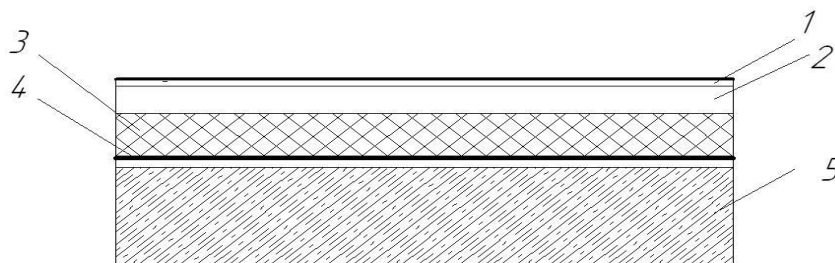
Схема для розрахунку тепловтрат через підлогу в підвальному приміщенні: 1 – керамічна плитка; 2 – стяжка; 3 – утеплювач; 4 – гідроізоляція; 5 - стяжка
